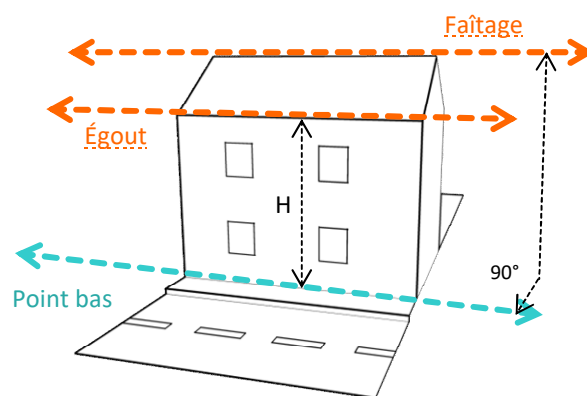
Points de référence de la hauteur des constructions en recul des voies
